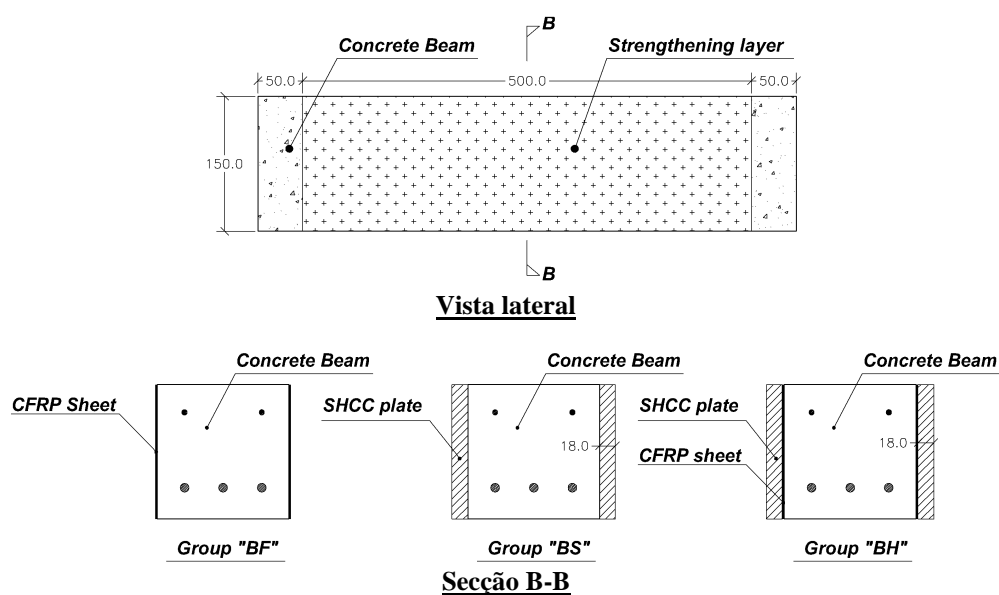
Detalhes dos sistemas de reforço ao corte adotados nas vigas da série "B"
